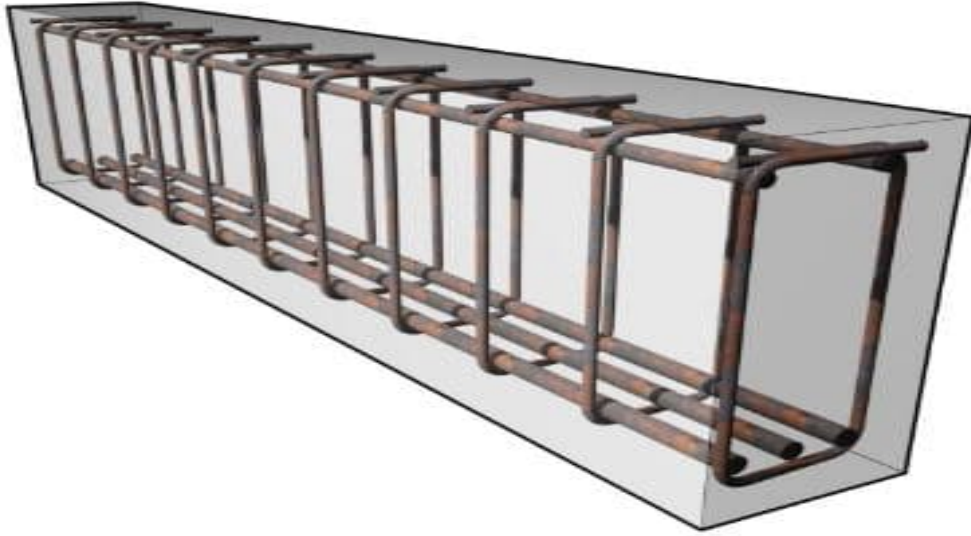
[] profil kesitli kiriş (Anonim 13)
